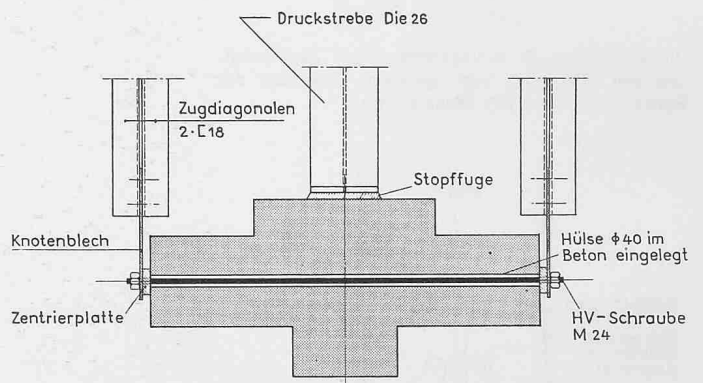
Anschluss des Stabilitätsverbandes an eine vorgefertigte Stütze mittels hochfester Schrauben. Masstab 1:30
